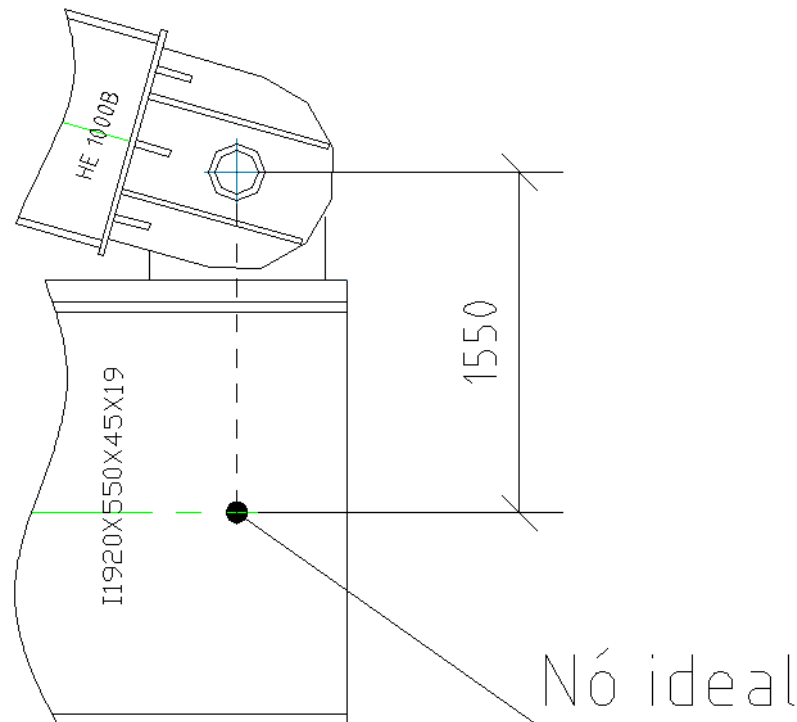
Afastamento da ligação do tirante da extremidade da lança à lança (aspeto construtivo)
